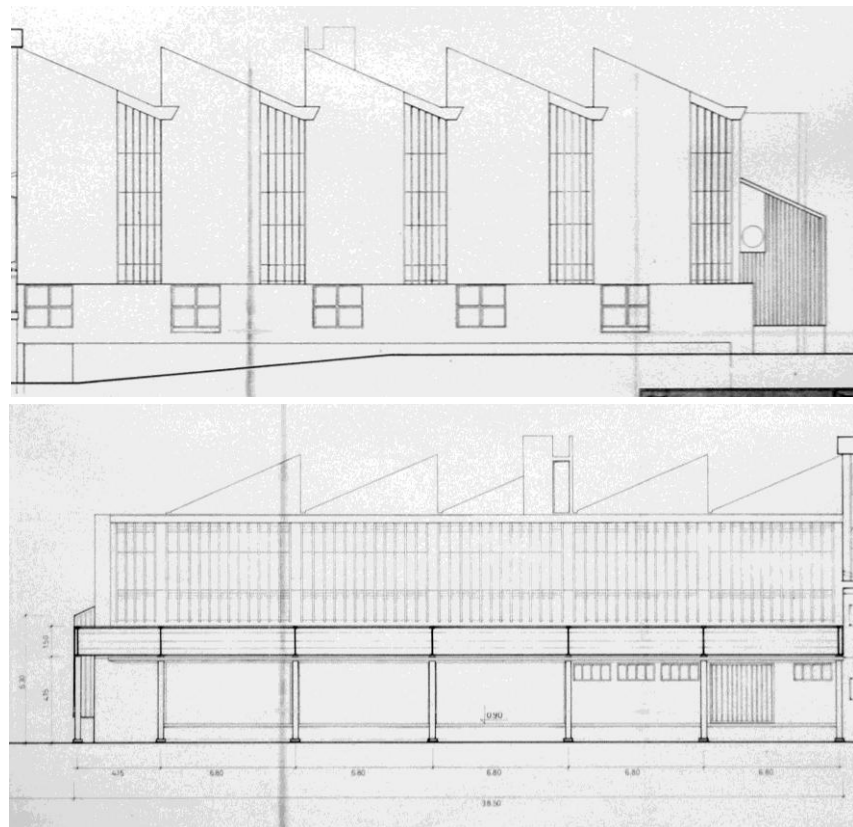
a 103: fachadas poente e nascente do volume de armazéns
